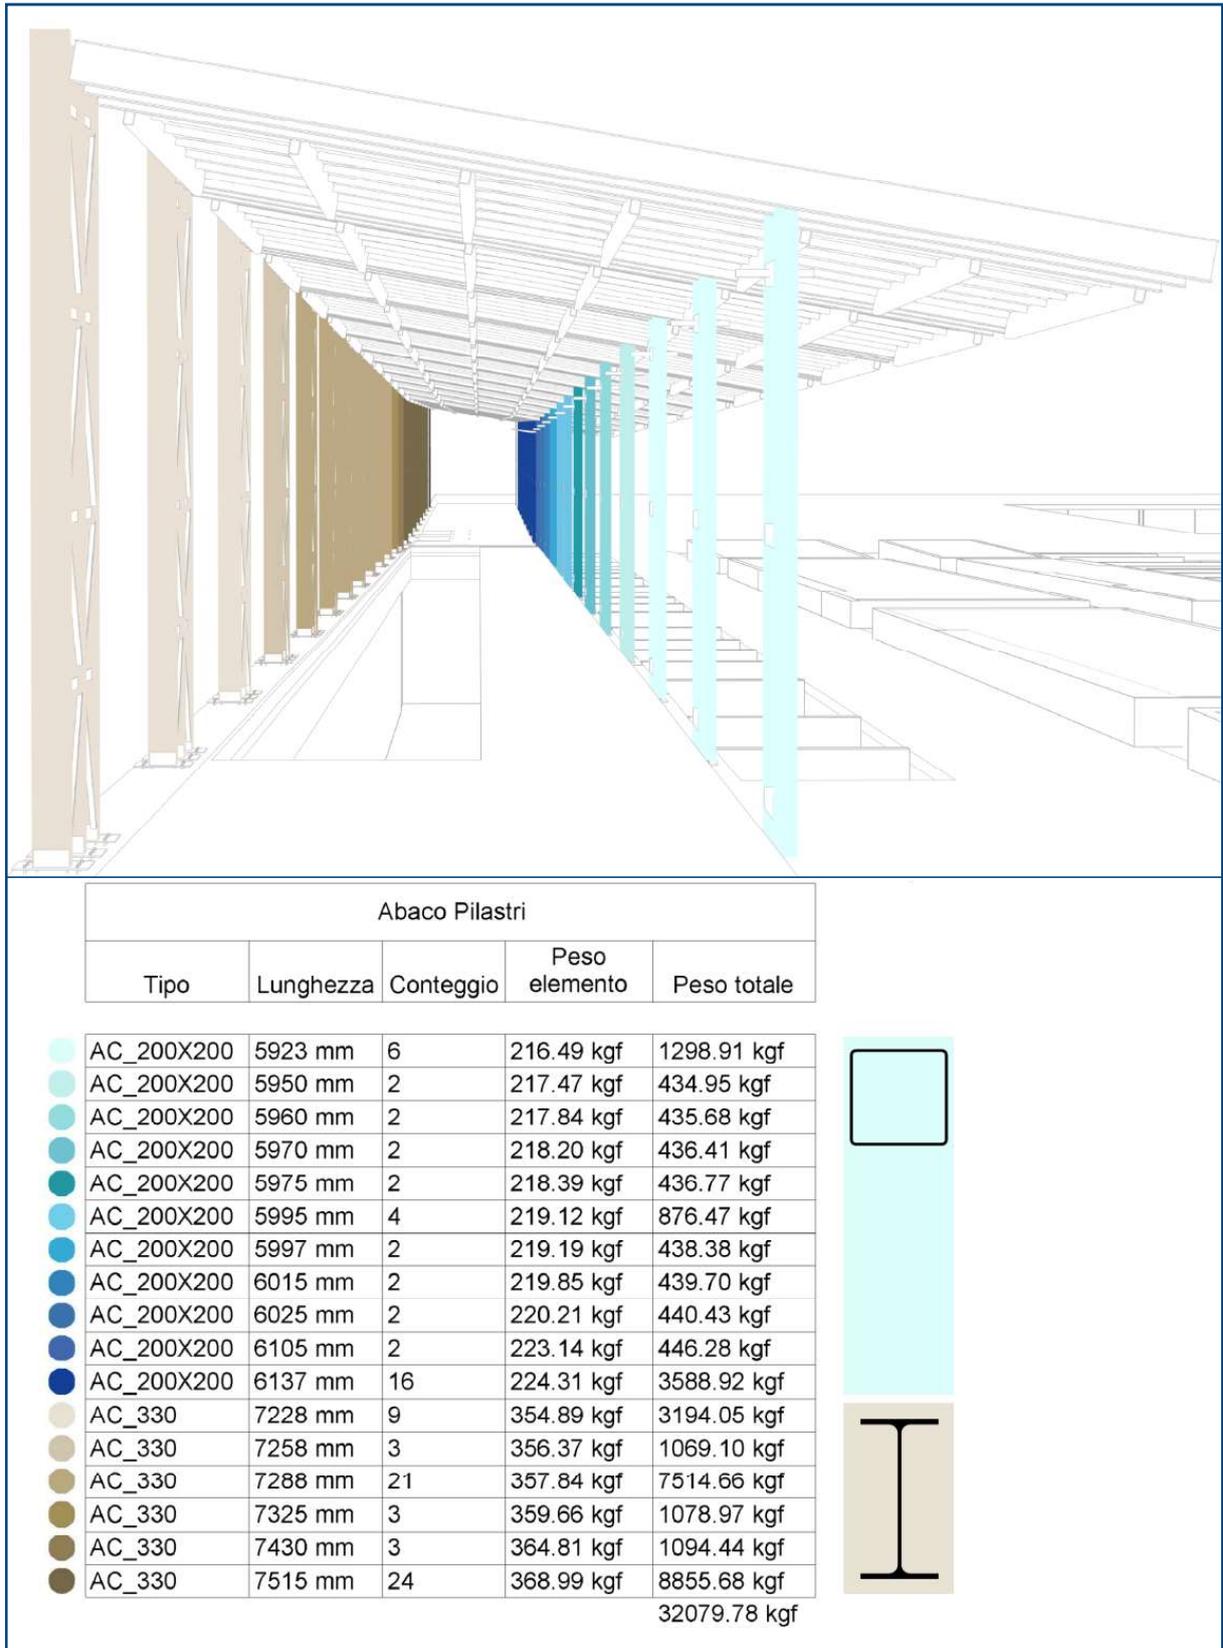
Vista tematica ed Abaco nel modello strutturale: variazione in altezza dei pilastri. Filtro applicato al parametro "Lunghezza" dei pilastri strutturali.
